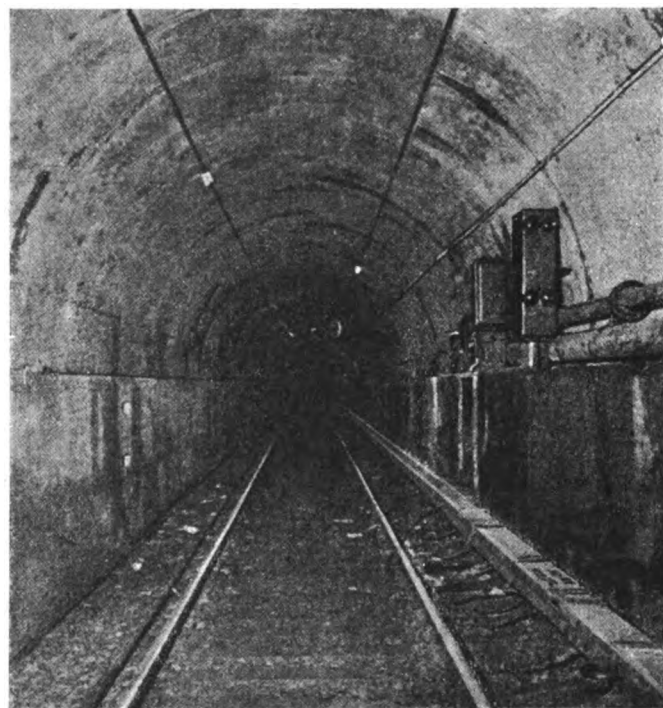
I tunnels sottomarini di New-York. - Vista di un tunnel in esercizio.
